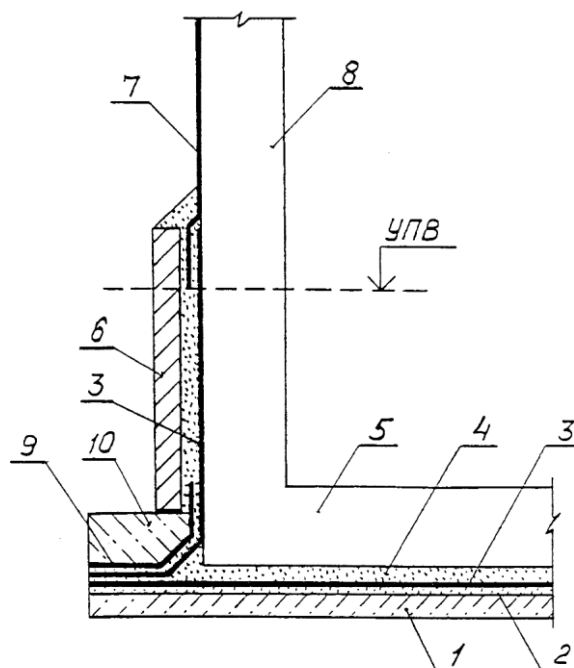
Оклеенная гидроизоляция тоннеля при наличии подземных вод
